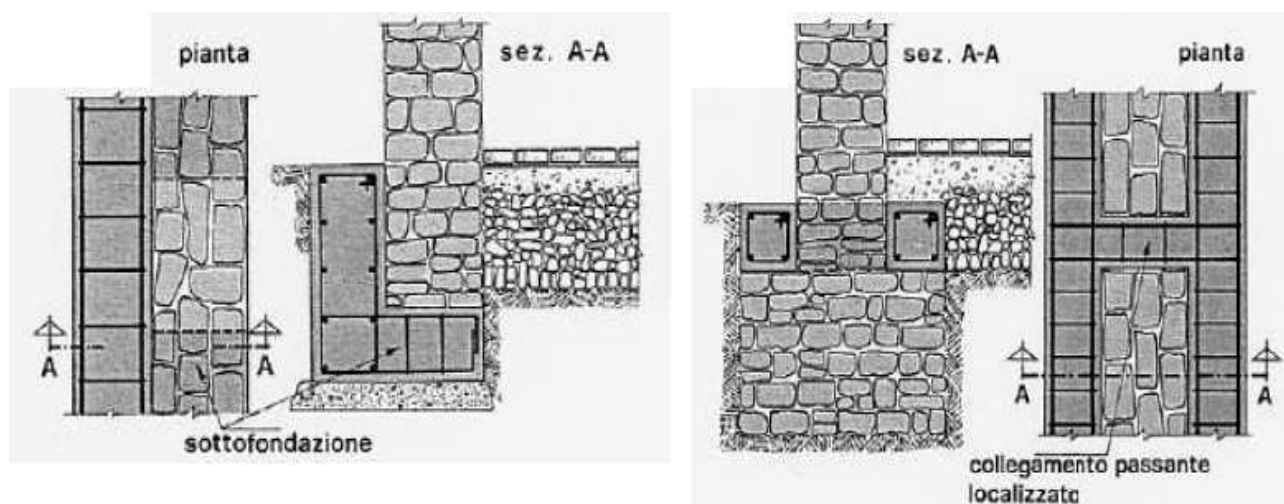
Allargamento della fondazione mediante cordoli in c.a.
